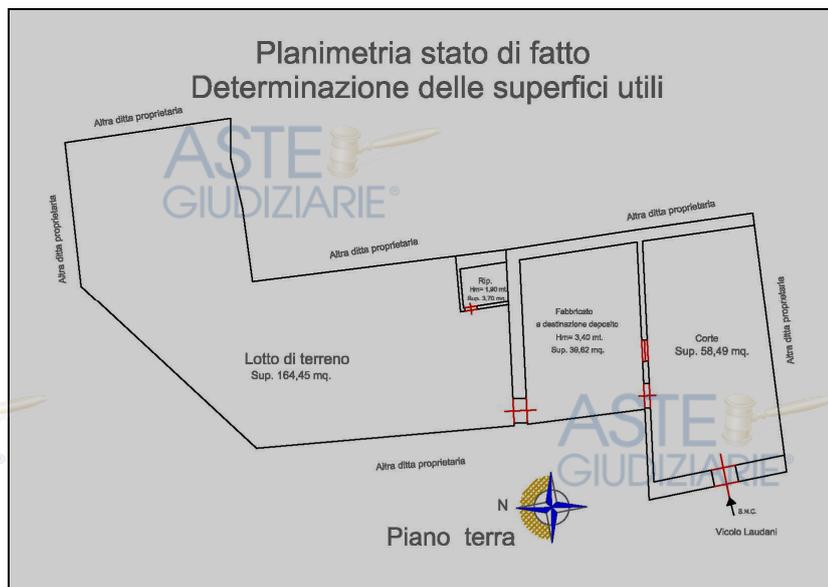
Visualizzazione della planimetria di insieme degli immobili con indicazione delle superfici utili
